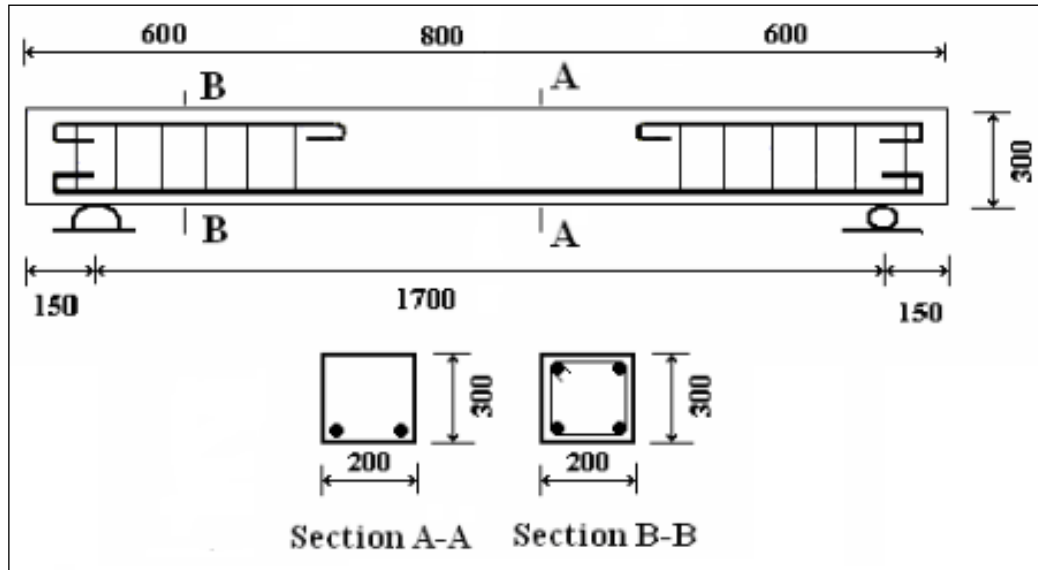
Détails des poutres testées (Mohammad et al. (2013)).
